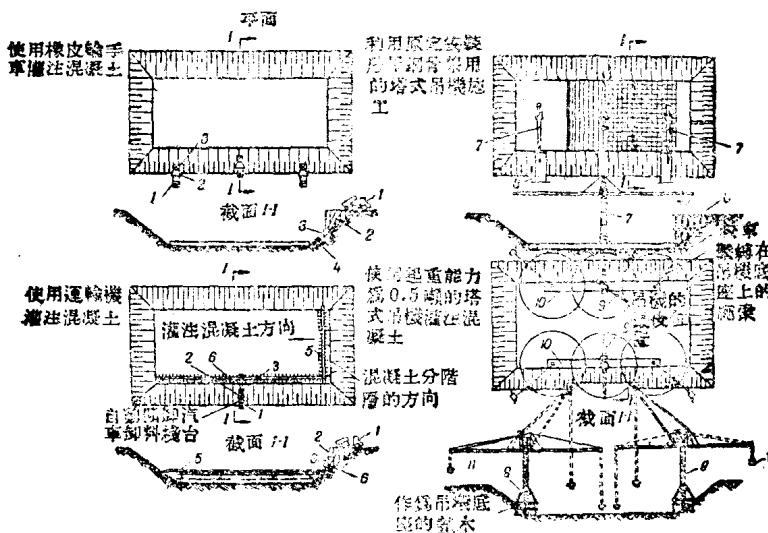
建築基礎的幾種鋼筋混凝土施工方案的概略圖
